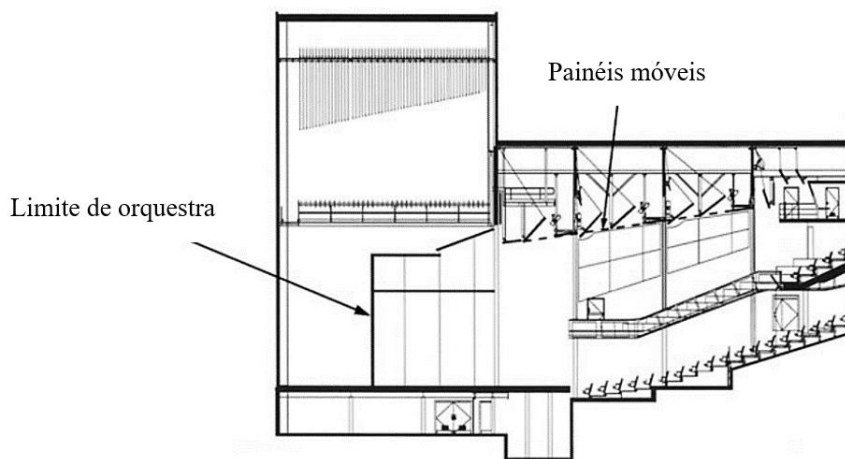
Secção longitudinal do *Bruce Mason Theatre*, Auckland, Nova Zelândia, evidenciando a utilização de painéis móveis [13]
